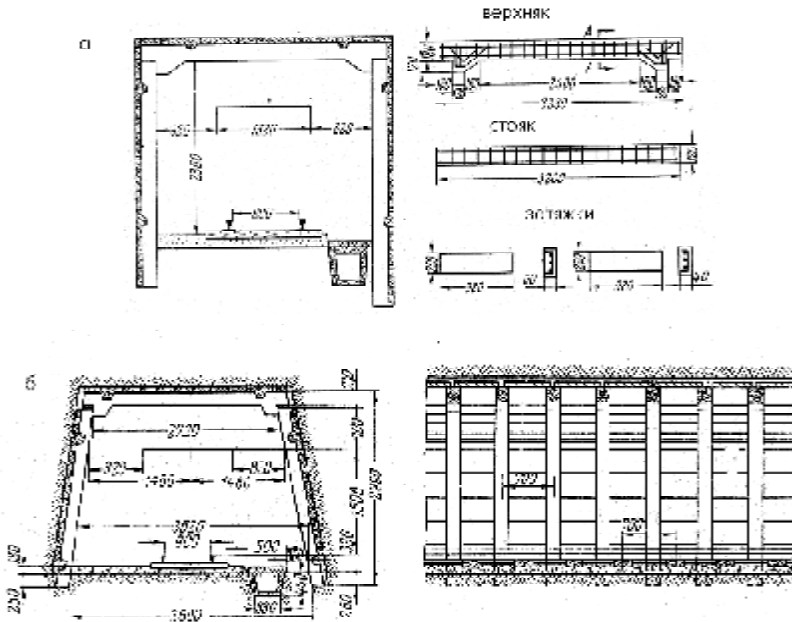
Конструкція рамного залізобетонного кріплення із суцільних елементів:
